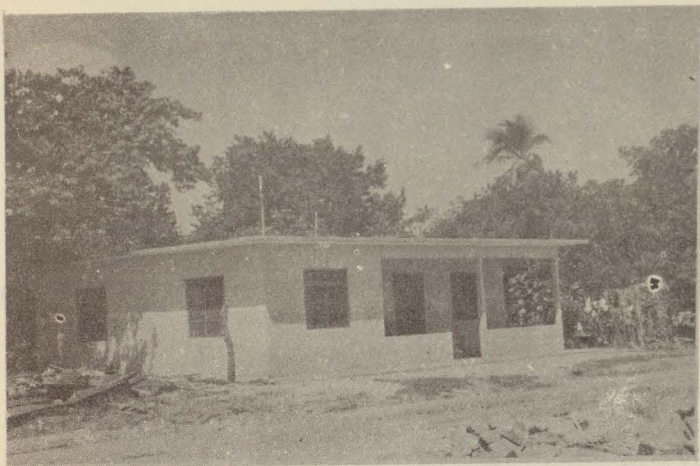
Casa de ladrillos de construcción moderna, en Jáltipan. No sufrió daños.
